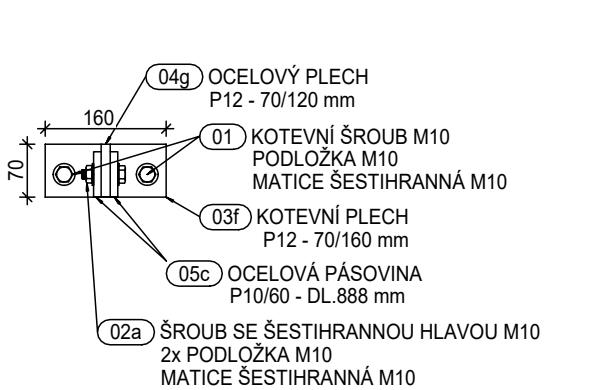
SLOUPEK SCHODIŠTĚ KOTVENÝ SHORA
